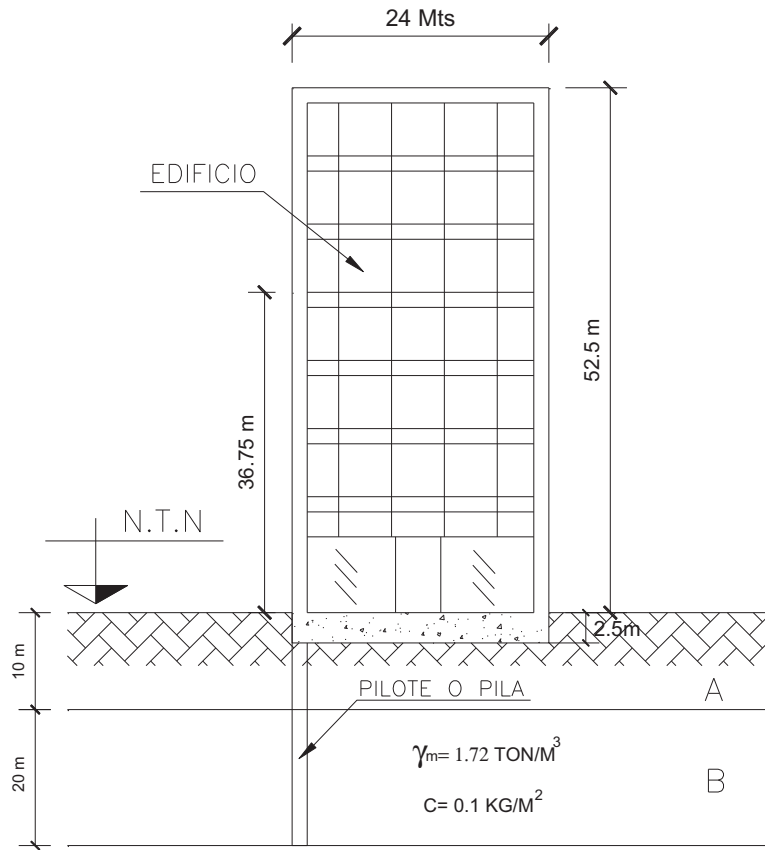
Edificio Con Cimentación a Base de Pilas con Esfuerzos en Punta
